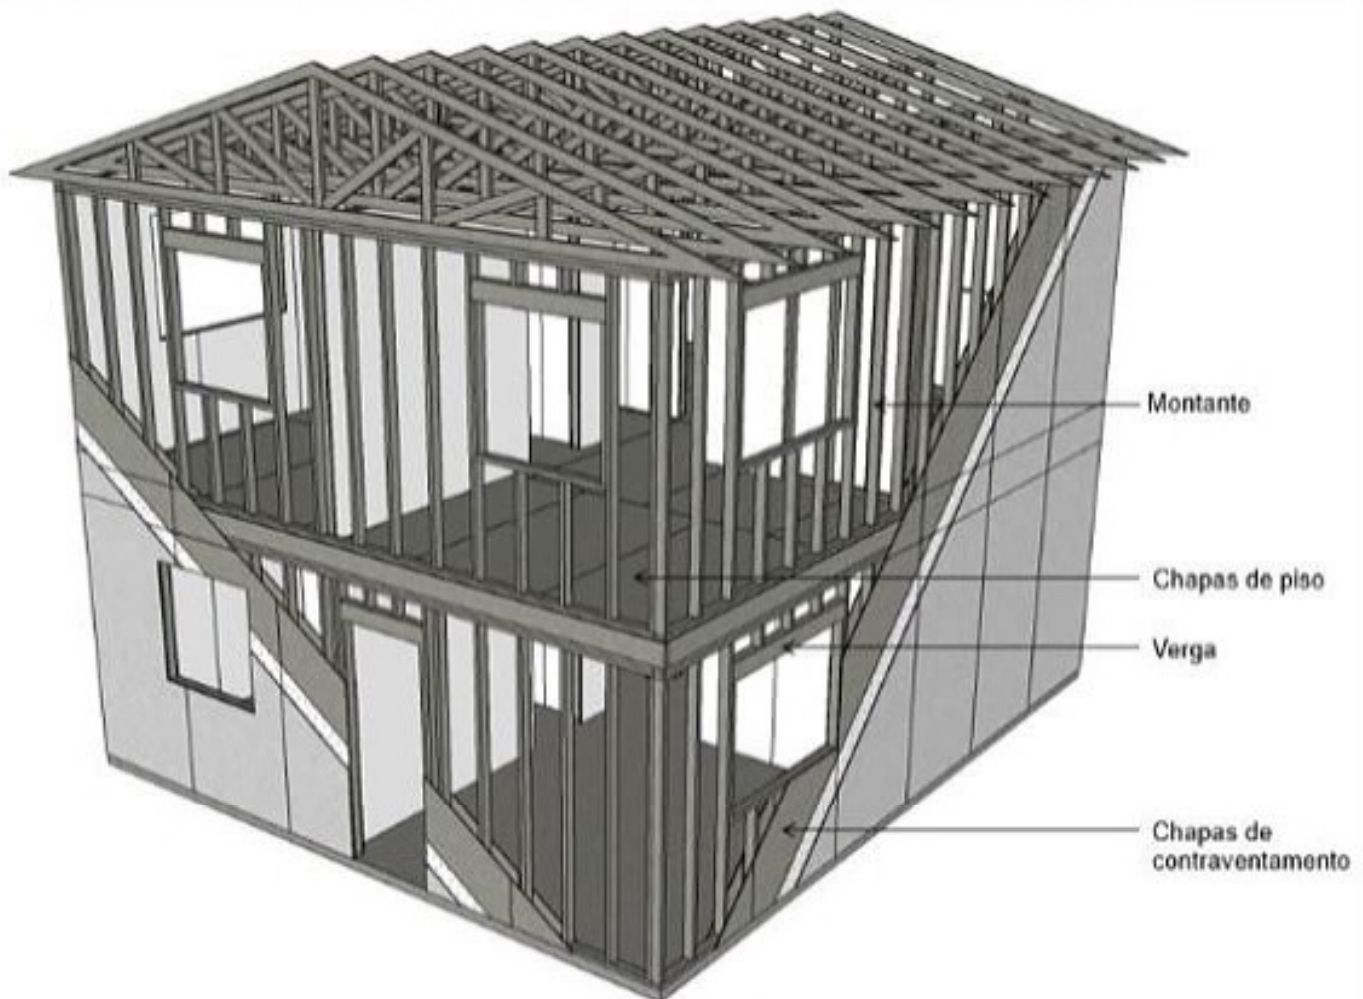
Esquema 3D de uma edificação de dois pavimentos em *light wood frame
